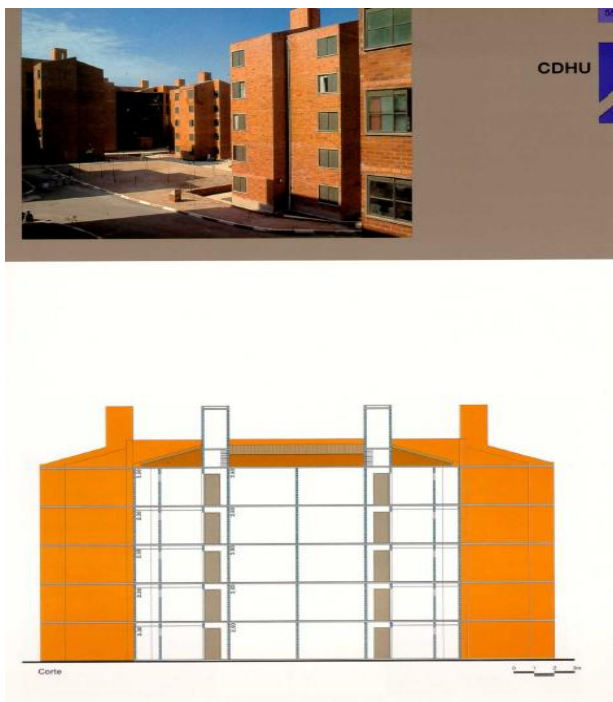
CDHU – Edifício em análise – Corte e fachada
